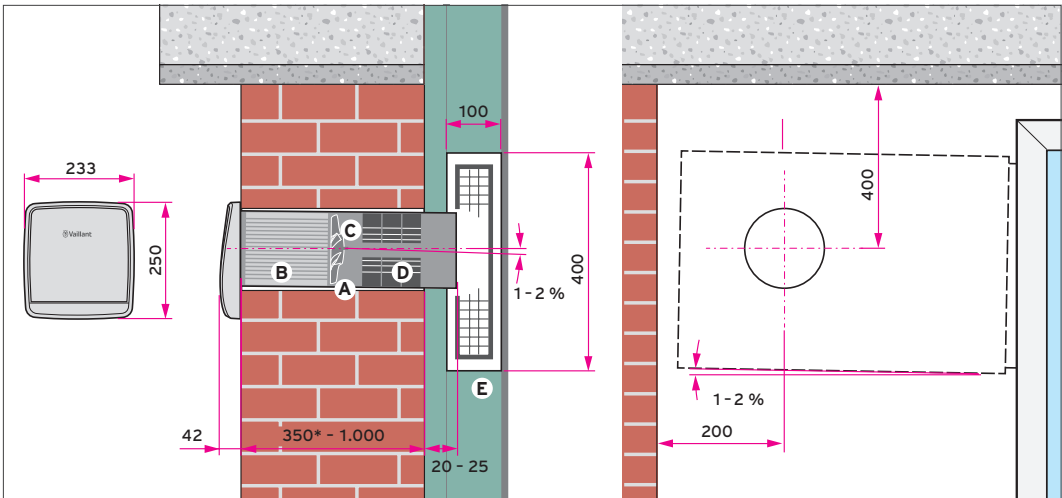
Fassadendurchführung mit Kernbohrung und Laibungsauslass
